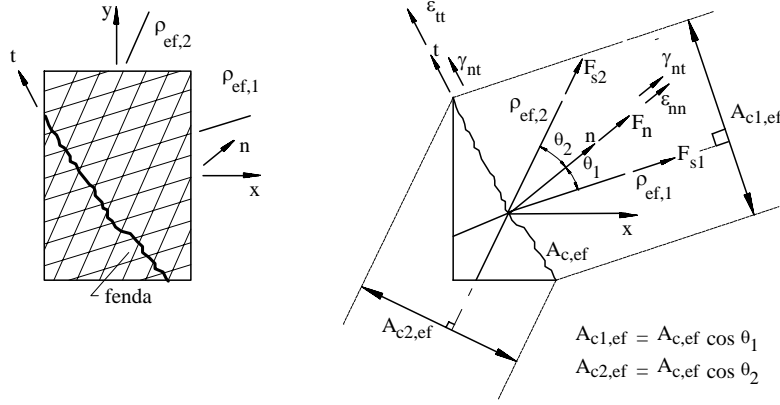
Forças nas armaduras de um elemento de betão armado fendilhado.
